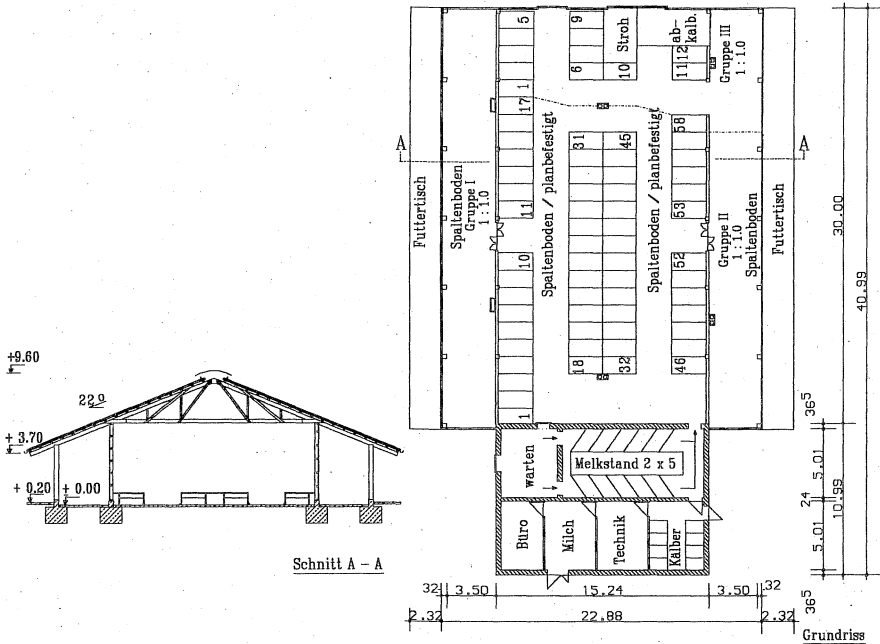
Vierreihiger Liegeboxenlaufstall für 70 Kühe mit Gruppenfütterung ohne Jungvieh
